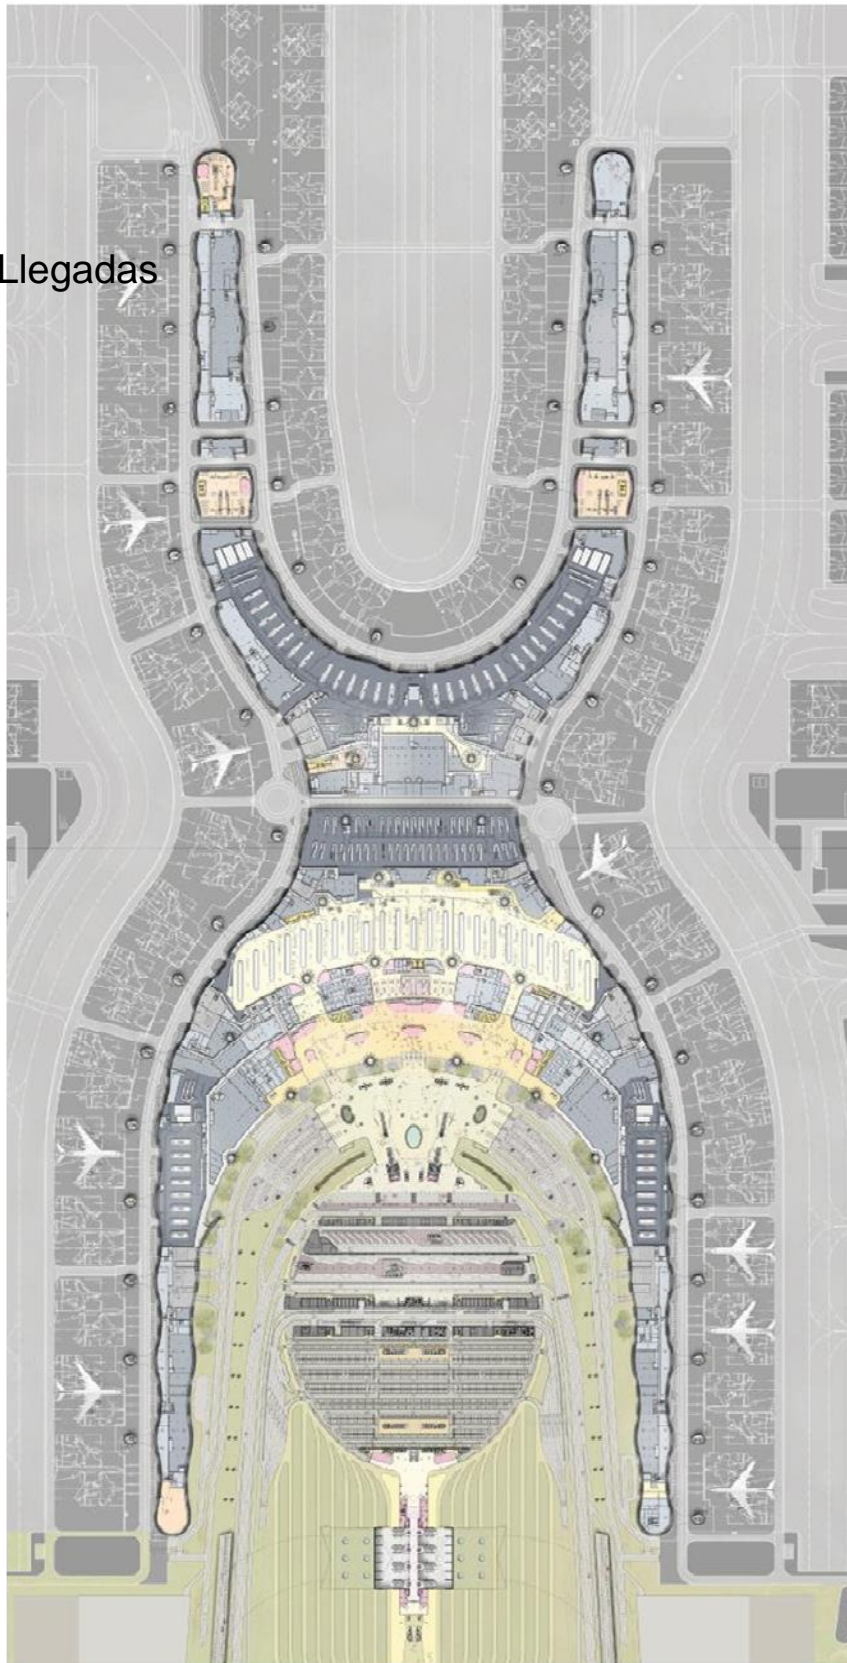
Plantas de la Disposición General de Distribución del Edificio Nivel 2 Llegadas
